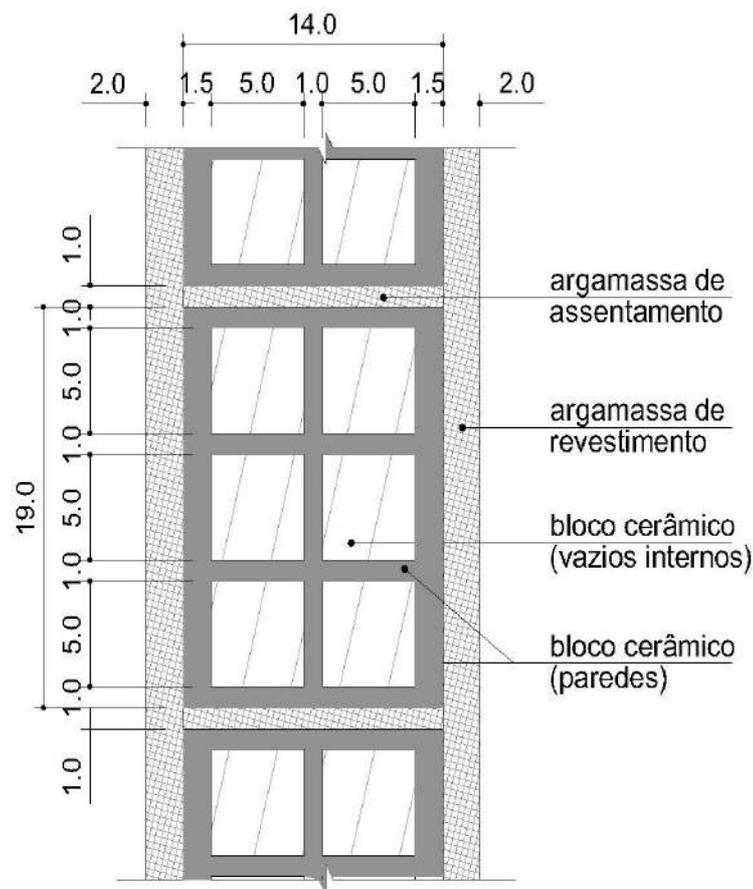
Detalhamento Construtivo da Alvenaria de Blocos Cerâmicos: Corte Vertical
